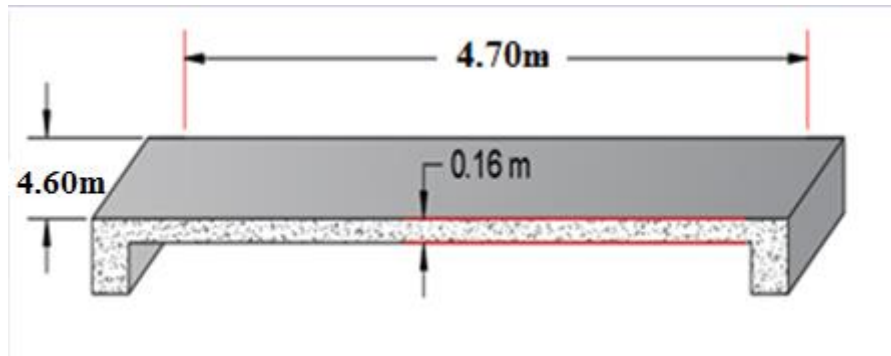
Coupe transversale du plancher à dalle pleine.
